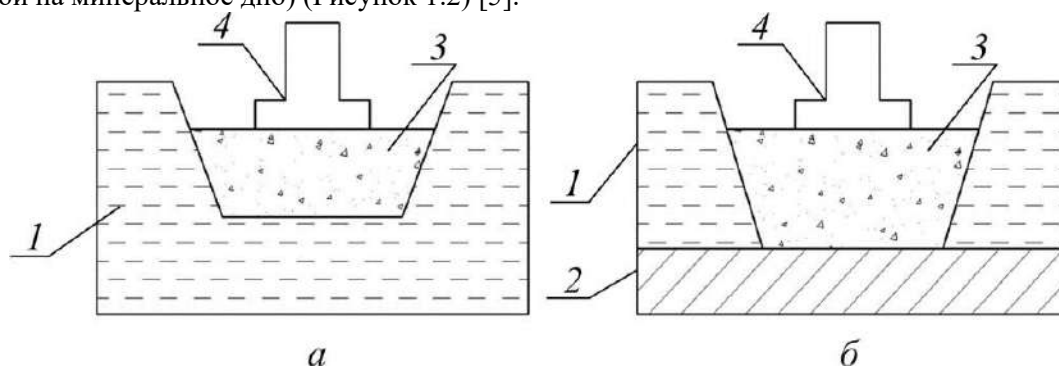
Пример песчаной подушки: а – висячая (плавающая); б – опертая (с посадкой на минеральное дно); 1 – слой слабого грунта; 2 – слой малосжимаемого грунта; 3 – грунтовая подушка; 4 – фундамент
